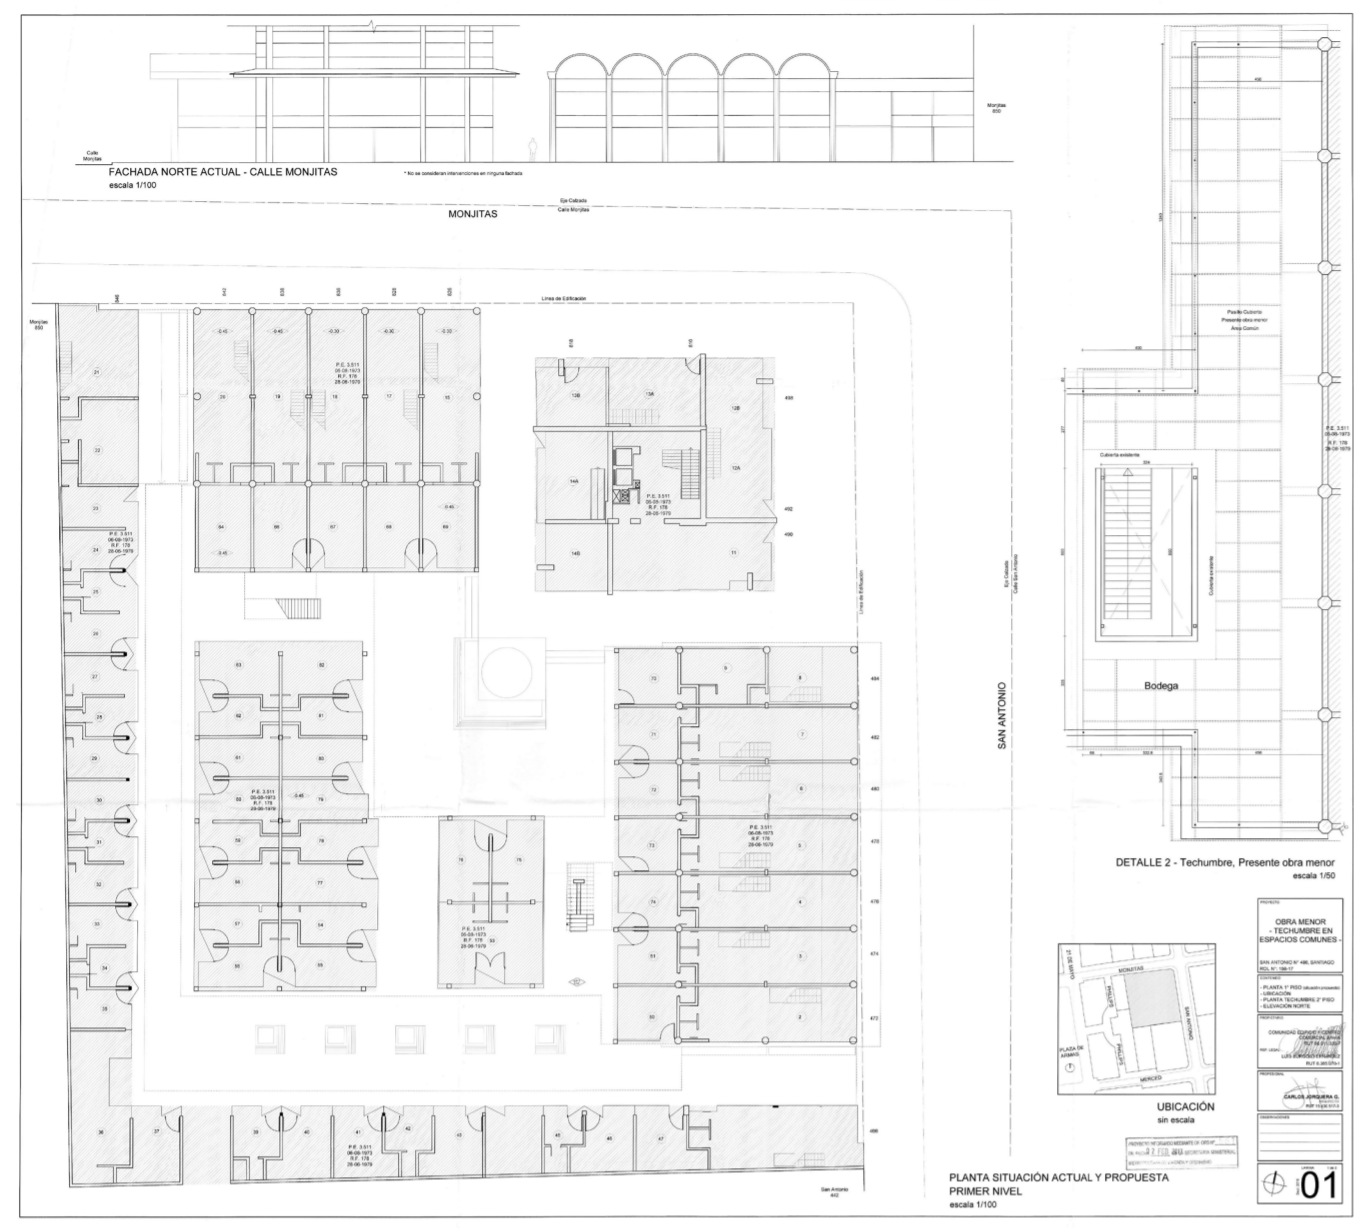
Archivo Plano Municipal. Planta baja.
